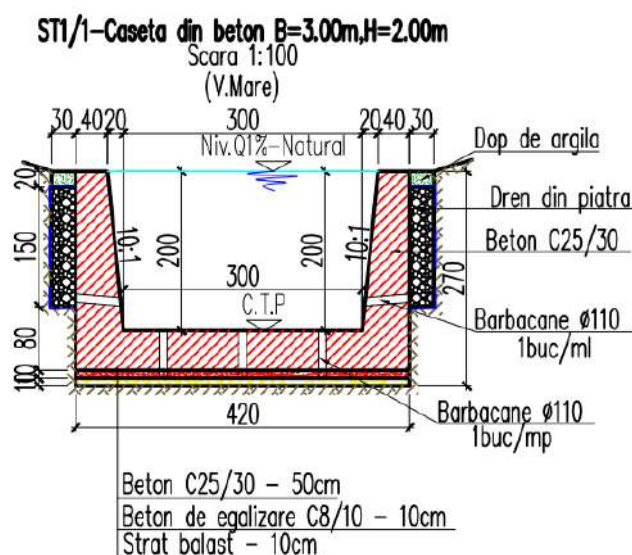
ST1/1 Casetă din beton (B= 3.00 m, H=2.00 m)
